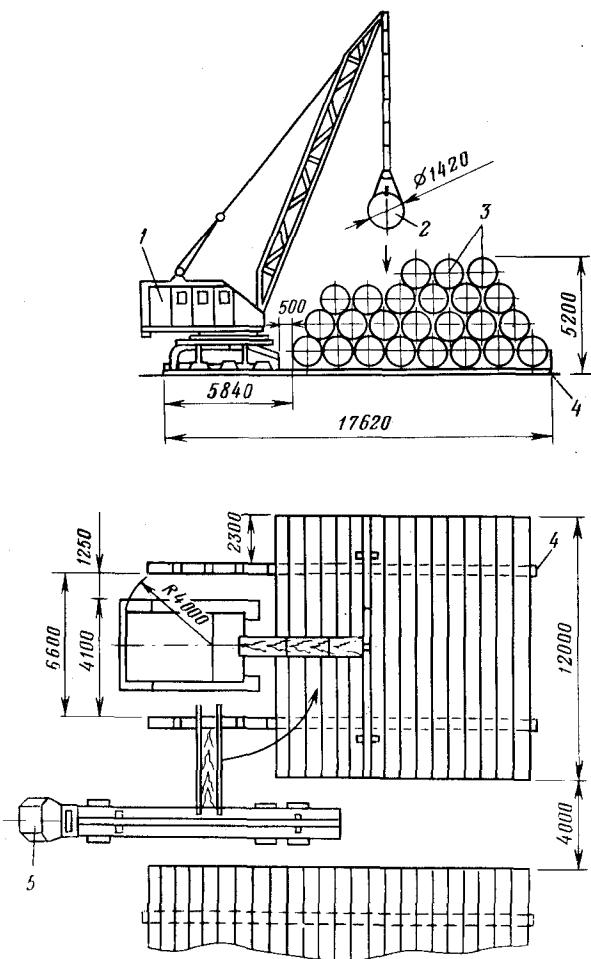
Схема складирования труб на стеллаже СР-1421 гусеничным краном (СКГ-40):
